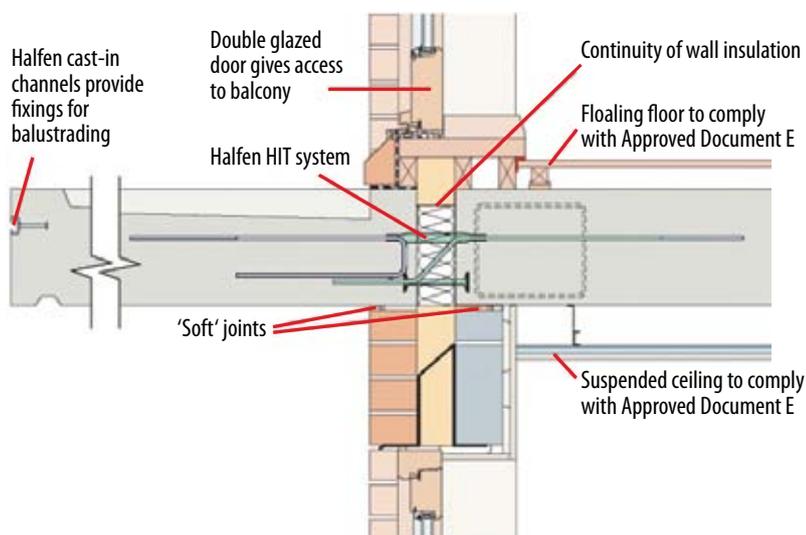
Теплоизолированное присоединение железобетонного балкона к междуэтажному перекрытию фирмы HALFEN DEHA предотвращает образование теплового моста
